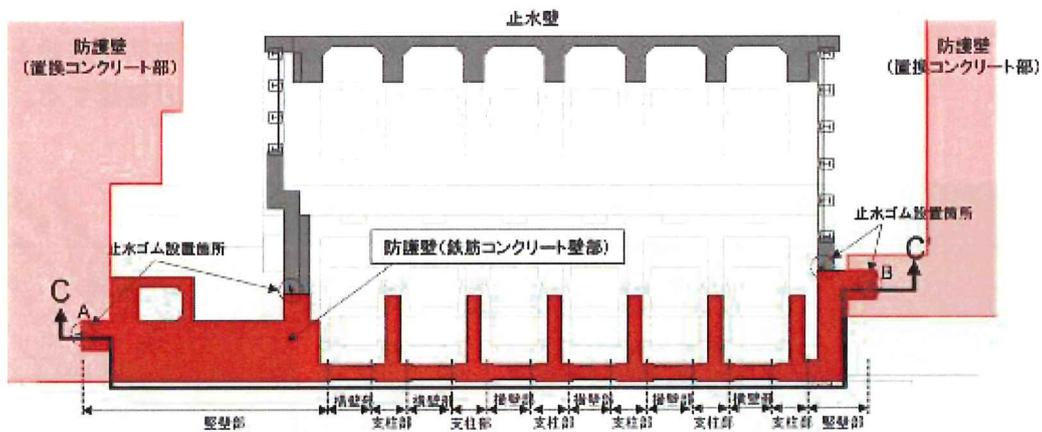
防護壁平面図（鉄筋コンクリート壁部拡大）
